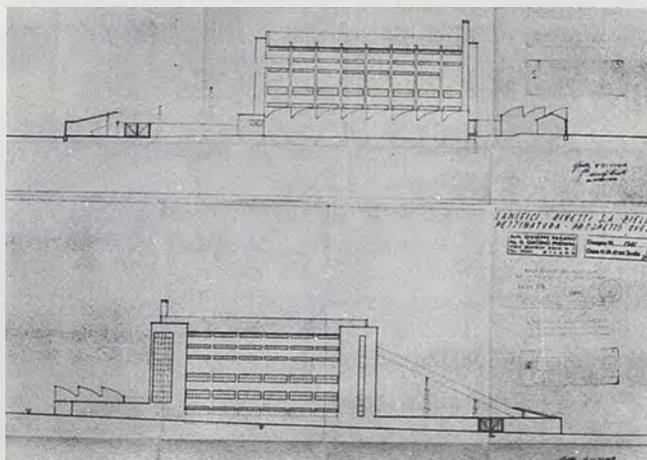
Ex Lanifici Rivetti: prospetto est e prospetto ovest.
